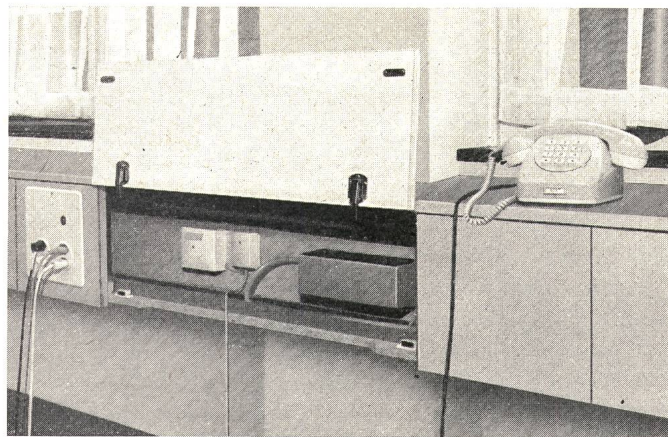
In bestehendem Bau nachträglich eingebauter Brüstungskanal
